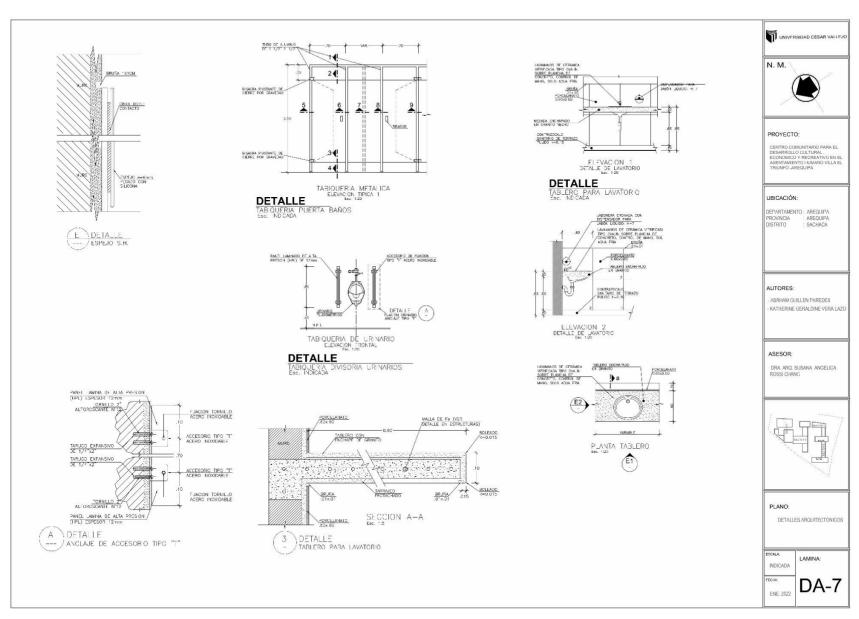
Plano de Detalles Arquitectónicos (Tabiquería puerta baños, Tabiquería divisoria, Detalle sanitarios) - Elaboración propia
